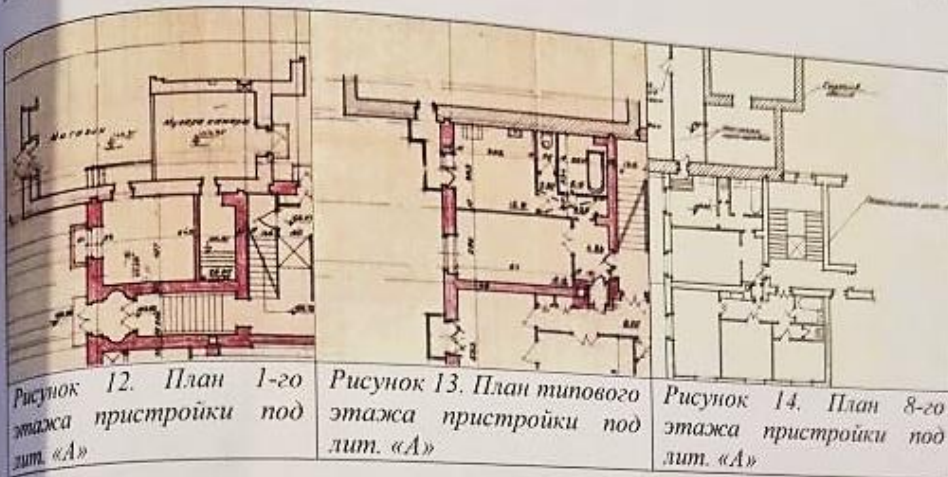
План 1-го этажа пристройки под лит. «А»
